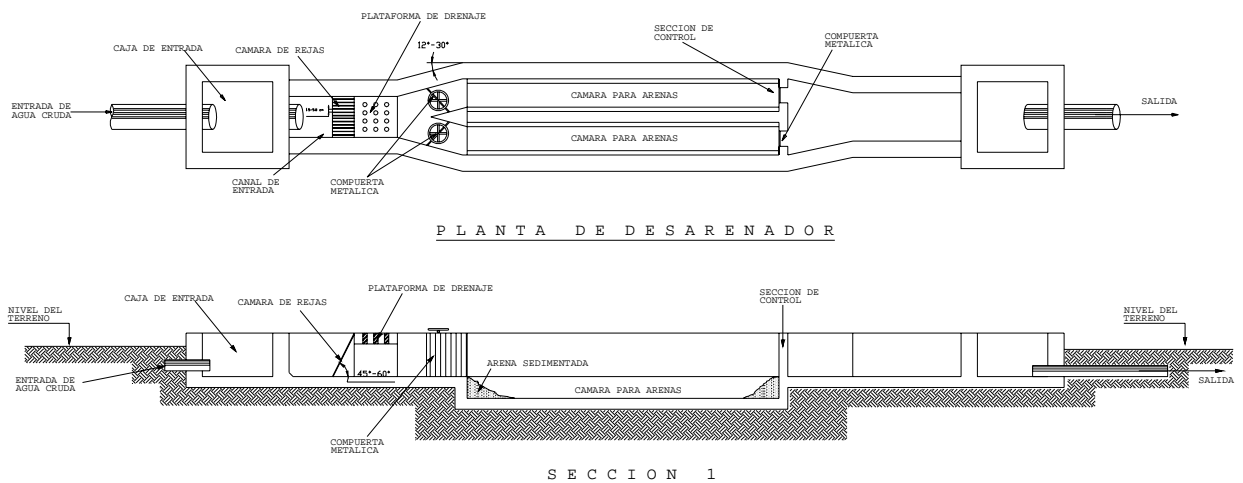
Desarenador (Planta y corte longitudinal).
